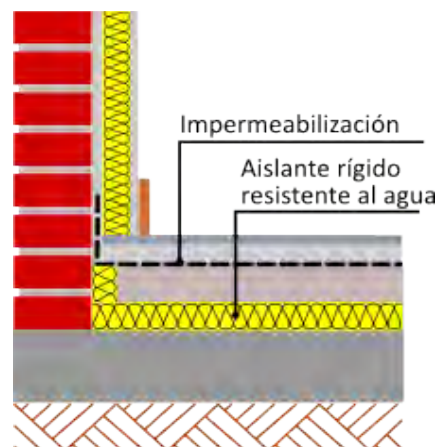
Suelo en contacto con el terreno. Impermeabilización sobre el aislante
